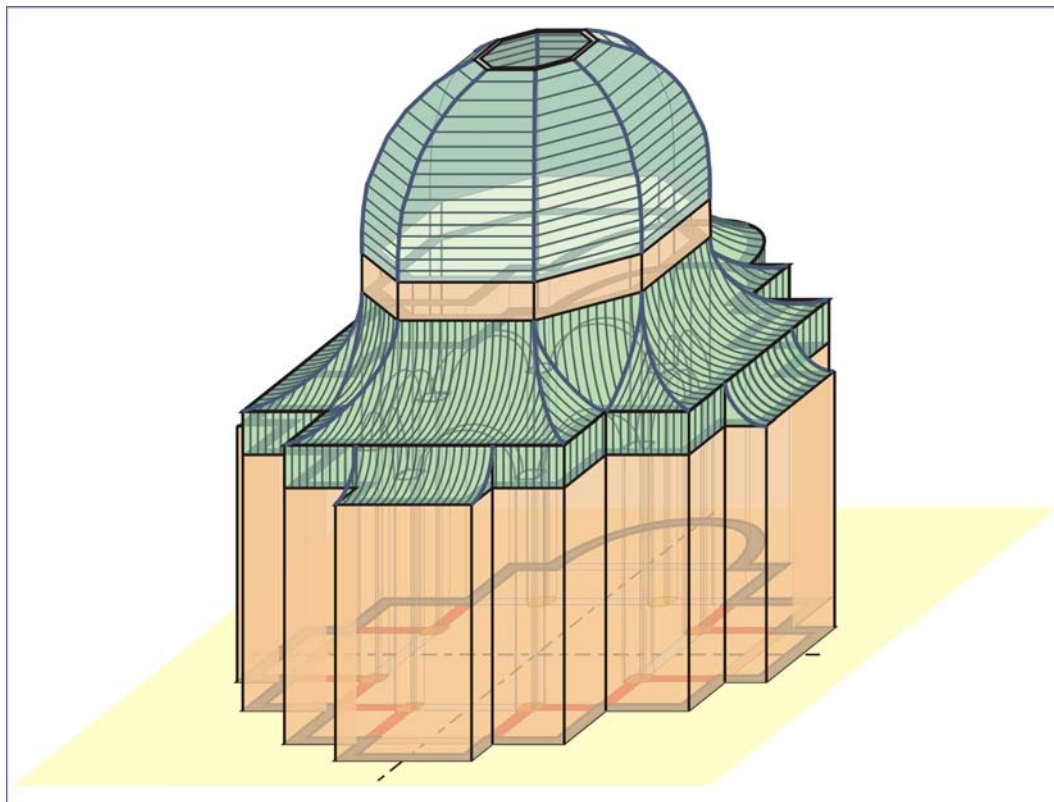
Transparente perspektivische Darstellung des Baukörpers und Geometrie der Dachflächen im Ersten Projekt der dresdner Frauenkirche. Darstellung ohne Laterne.
